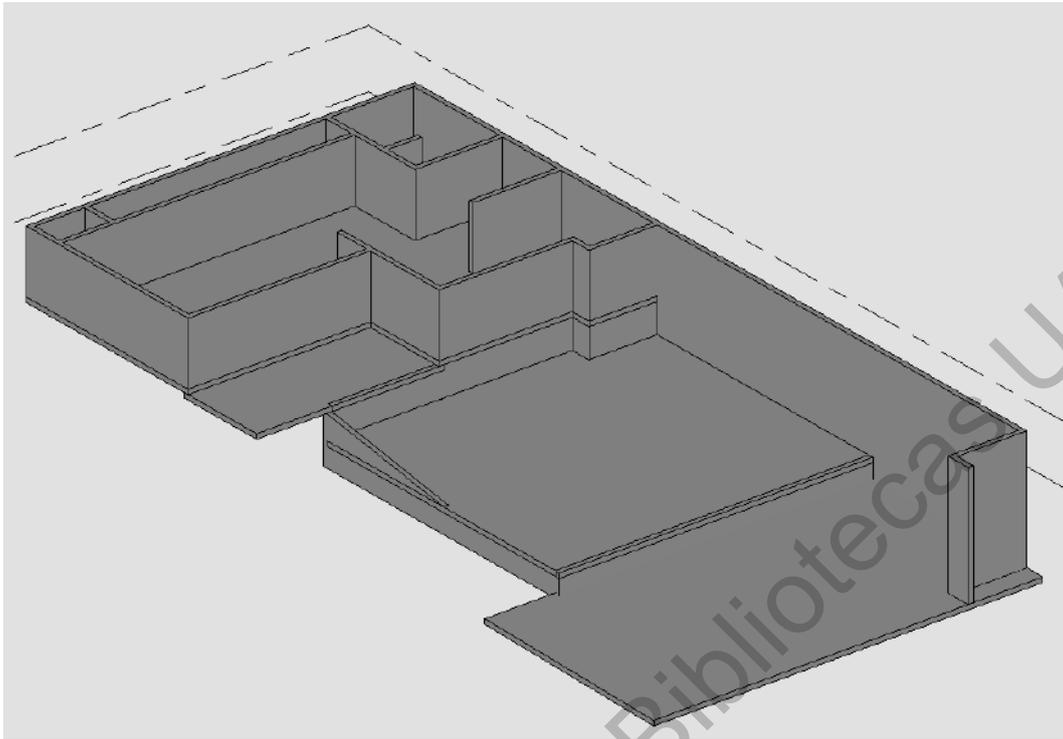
Suelos/Rampas de Planta baja del proyecto 002
